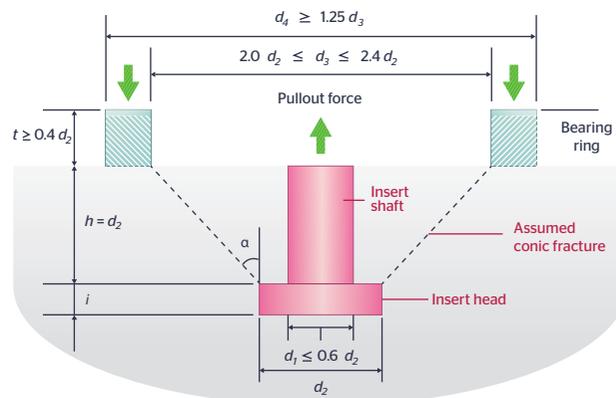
Vista en perfil de cómo realizar el ensayo de prueba de extracción.
